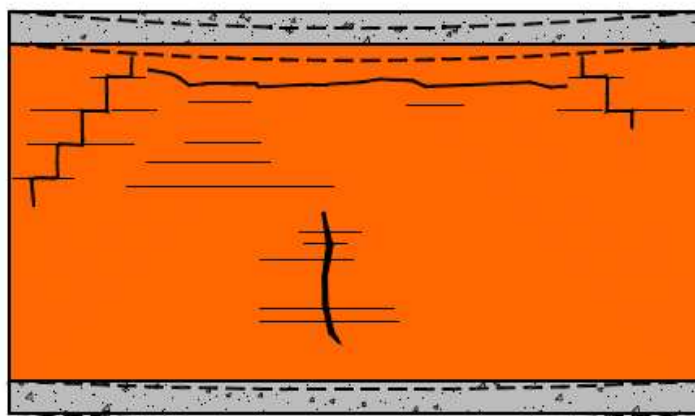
Fissuração devido á deformação do suporte: pavimento inferior menos deformável que o superior.[10]
